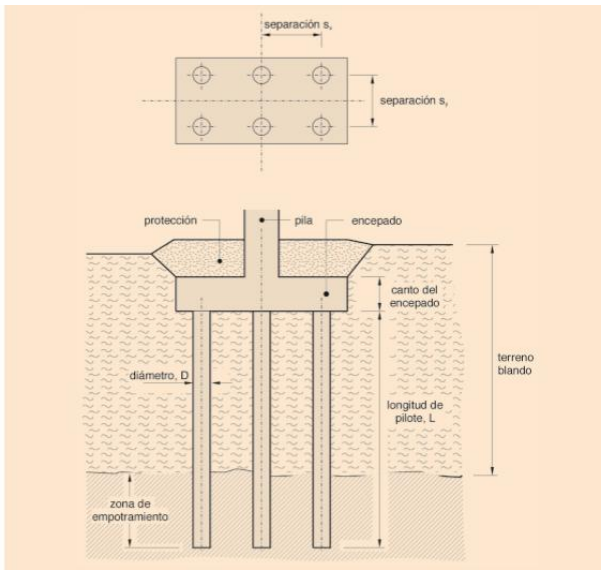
Ejemplo cimentación profunda mediante encepado y pilotes
